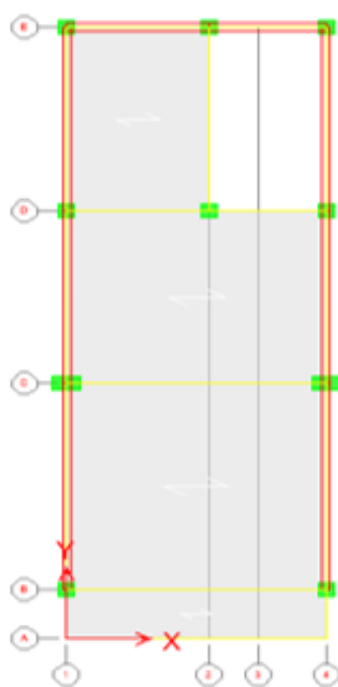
vista en planta del modelo estructural segundo nivel
